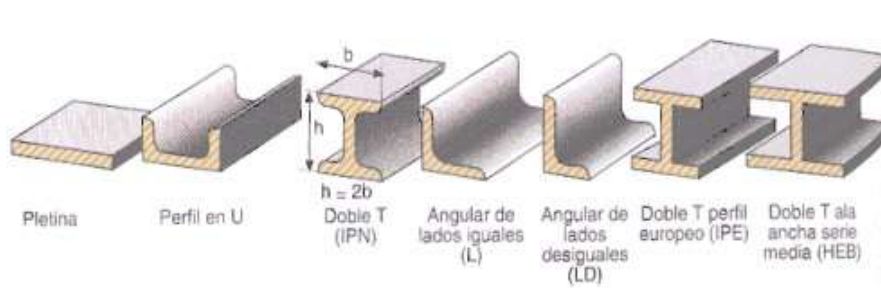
Perfiles metálicos. A la derecha, tipo IPE y HEB.
